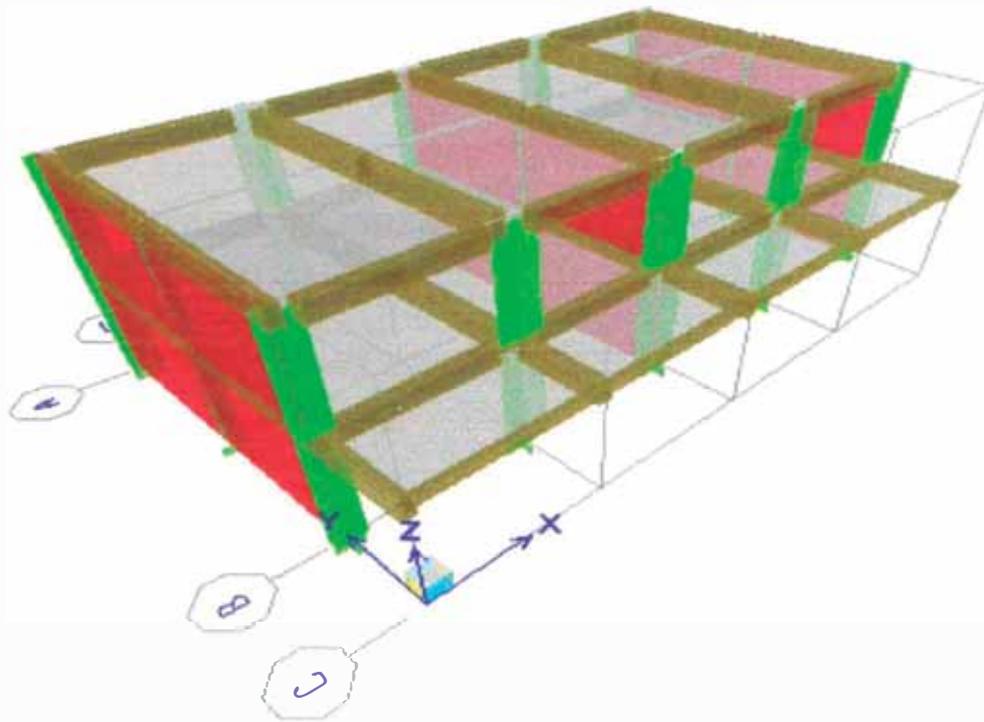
Vista en 3D del Módulo con todos sus elementos (vigas, columnas, muros y losas)
